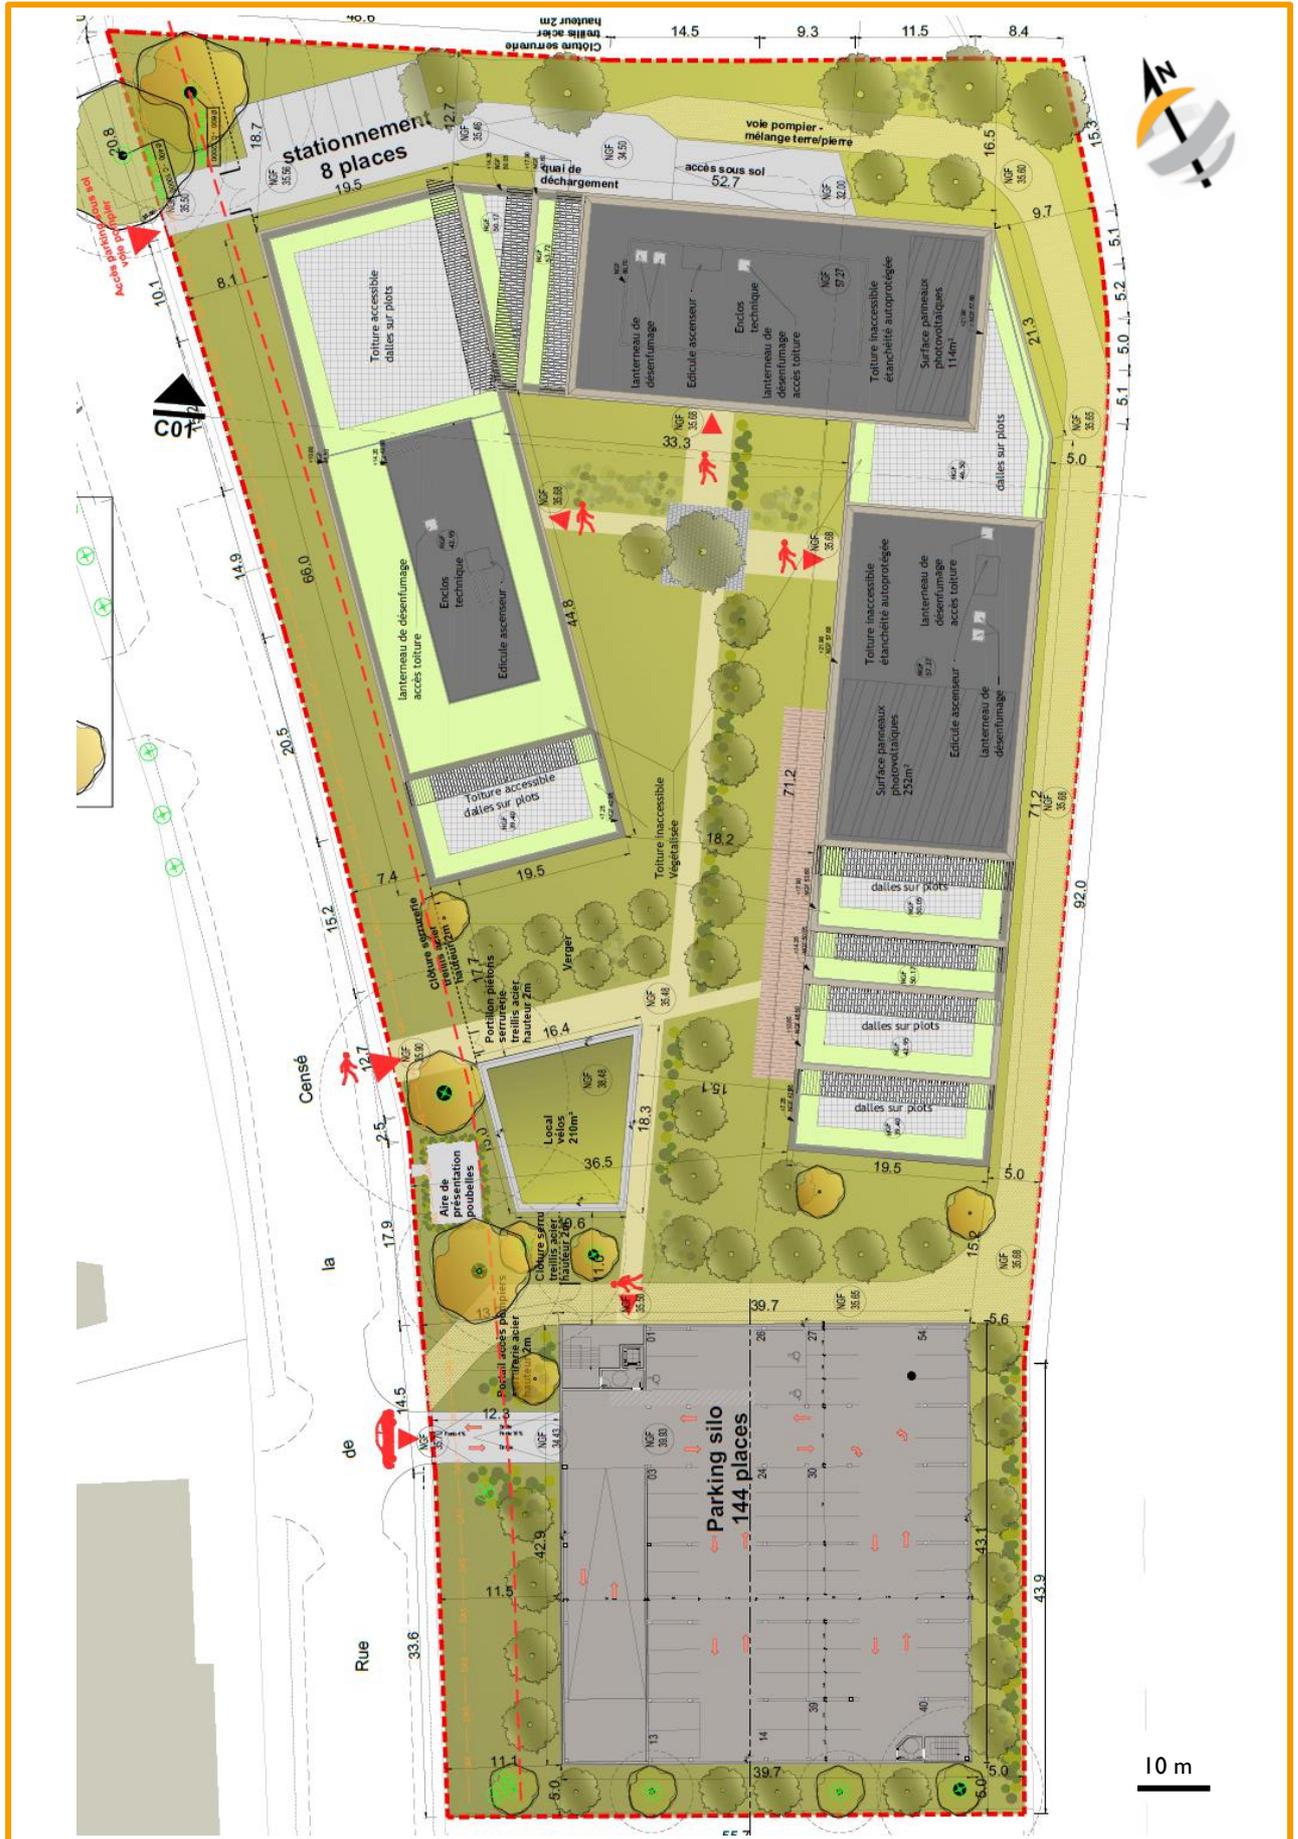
Plan de masse du projet d'aménagement (source : ADIM en date du 23/06/2023)
